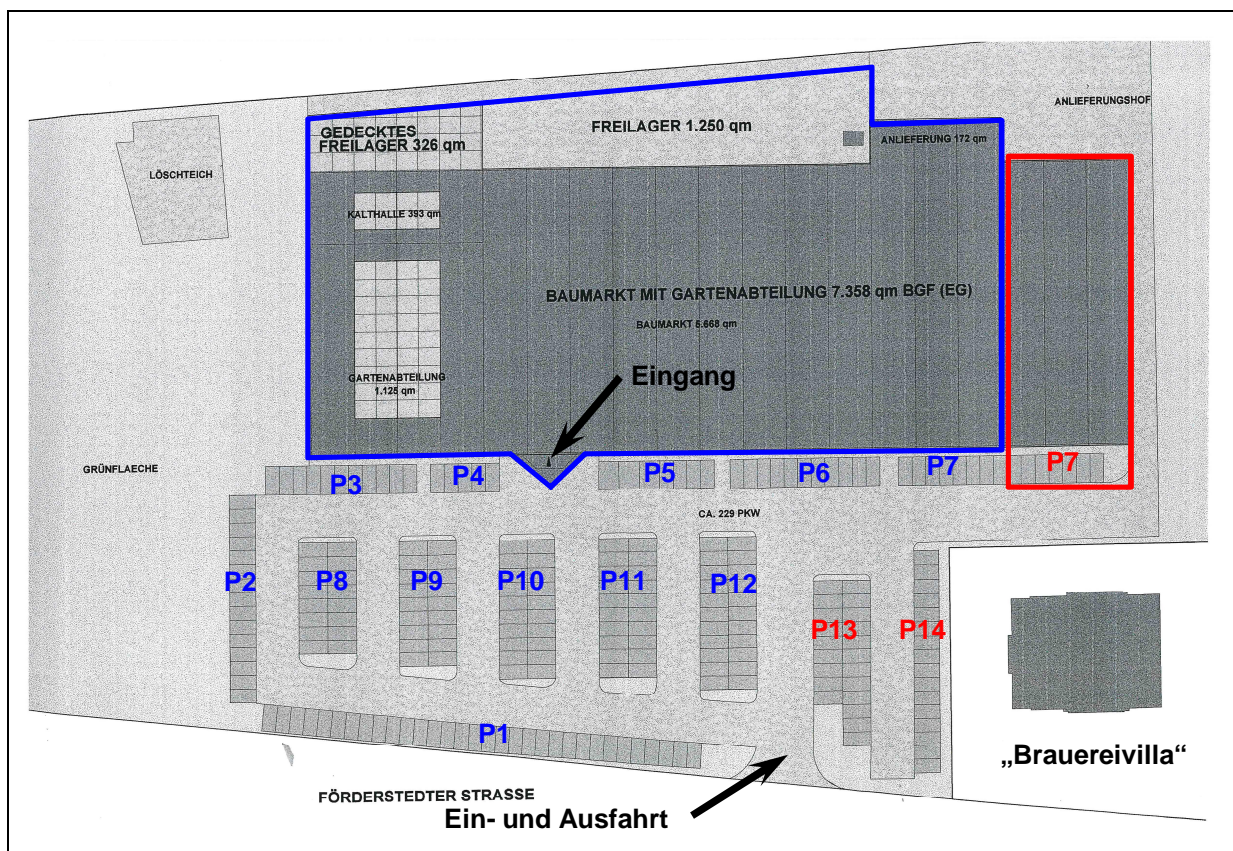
Lageplan des Hellweg-Baumarktes mit den Stellplätzen
